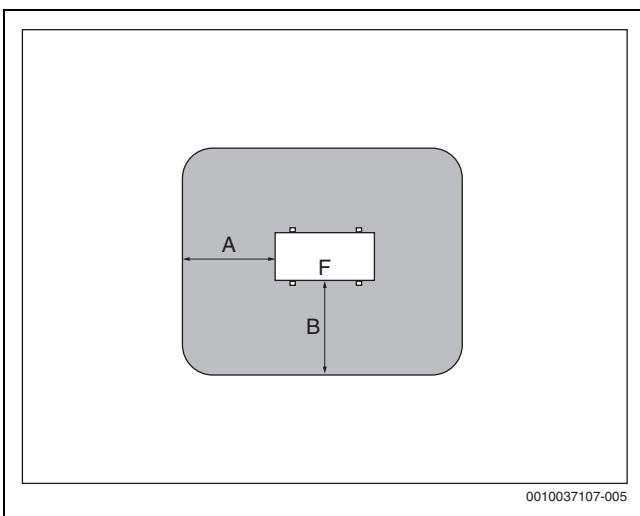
Espace de protection, placement au sol sur un terrain ou sous un toit-terrasse
